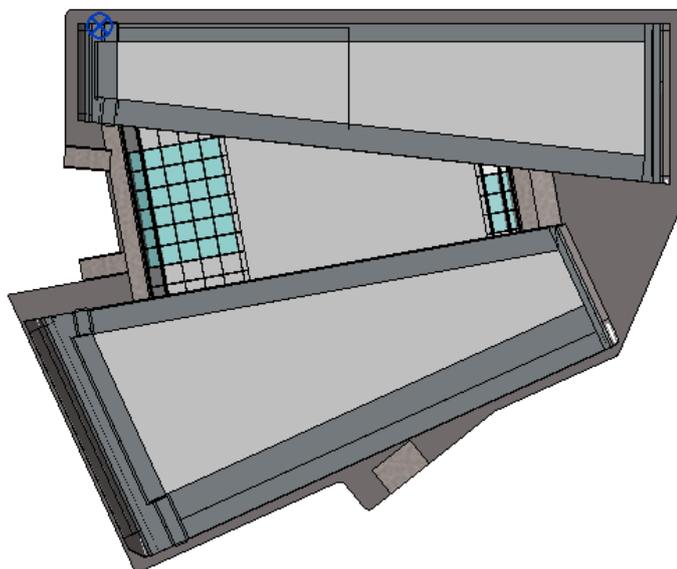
ATC - Vista in pianta dei corpi dei fabbricati
